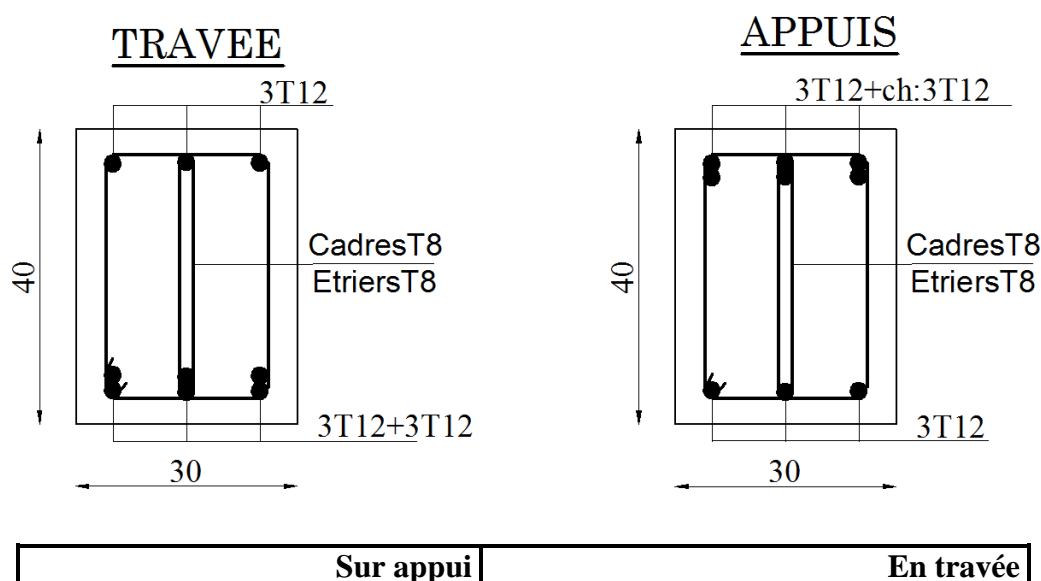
Ferrailage de la poutre secondaire sans voile
